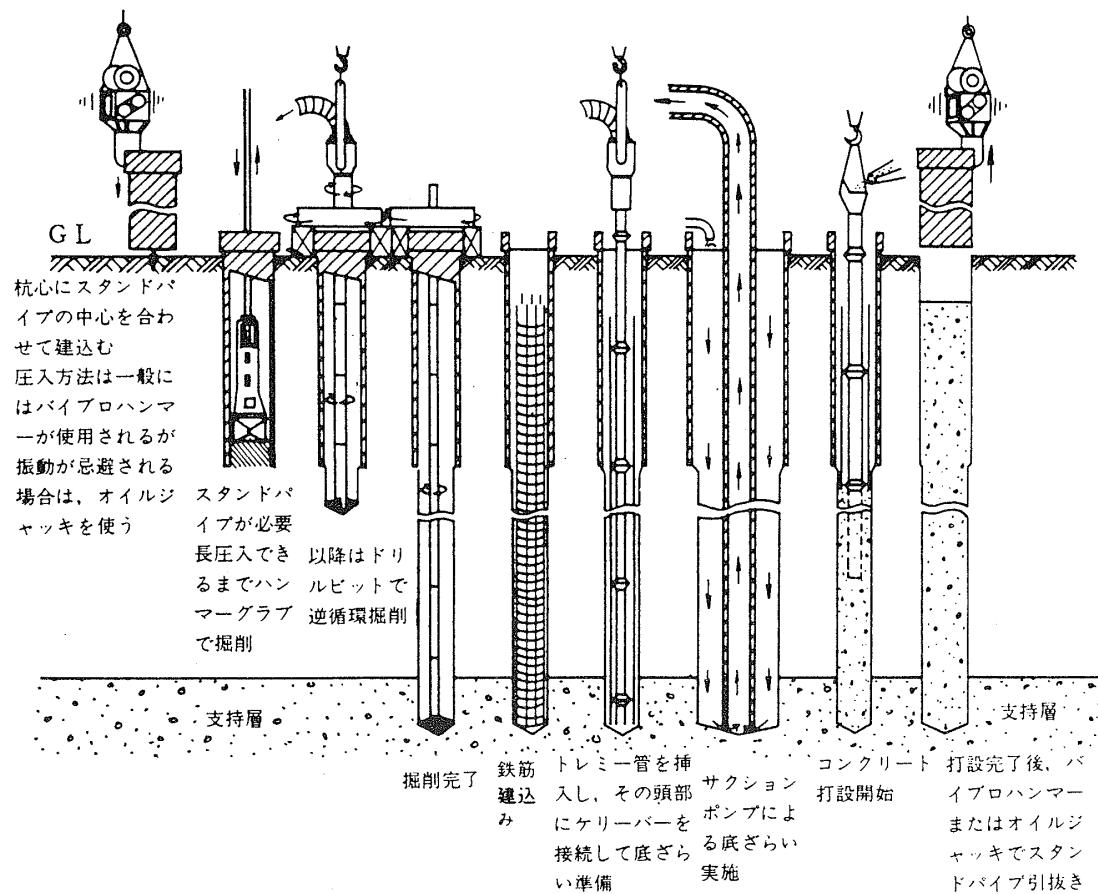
リバース工法施工順序図¹⁶⁴⁾
